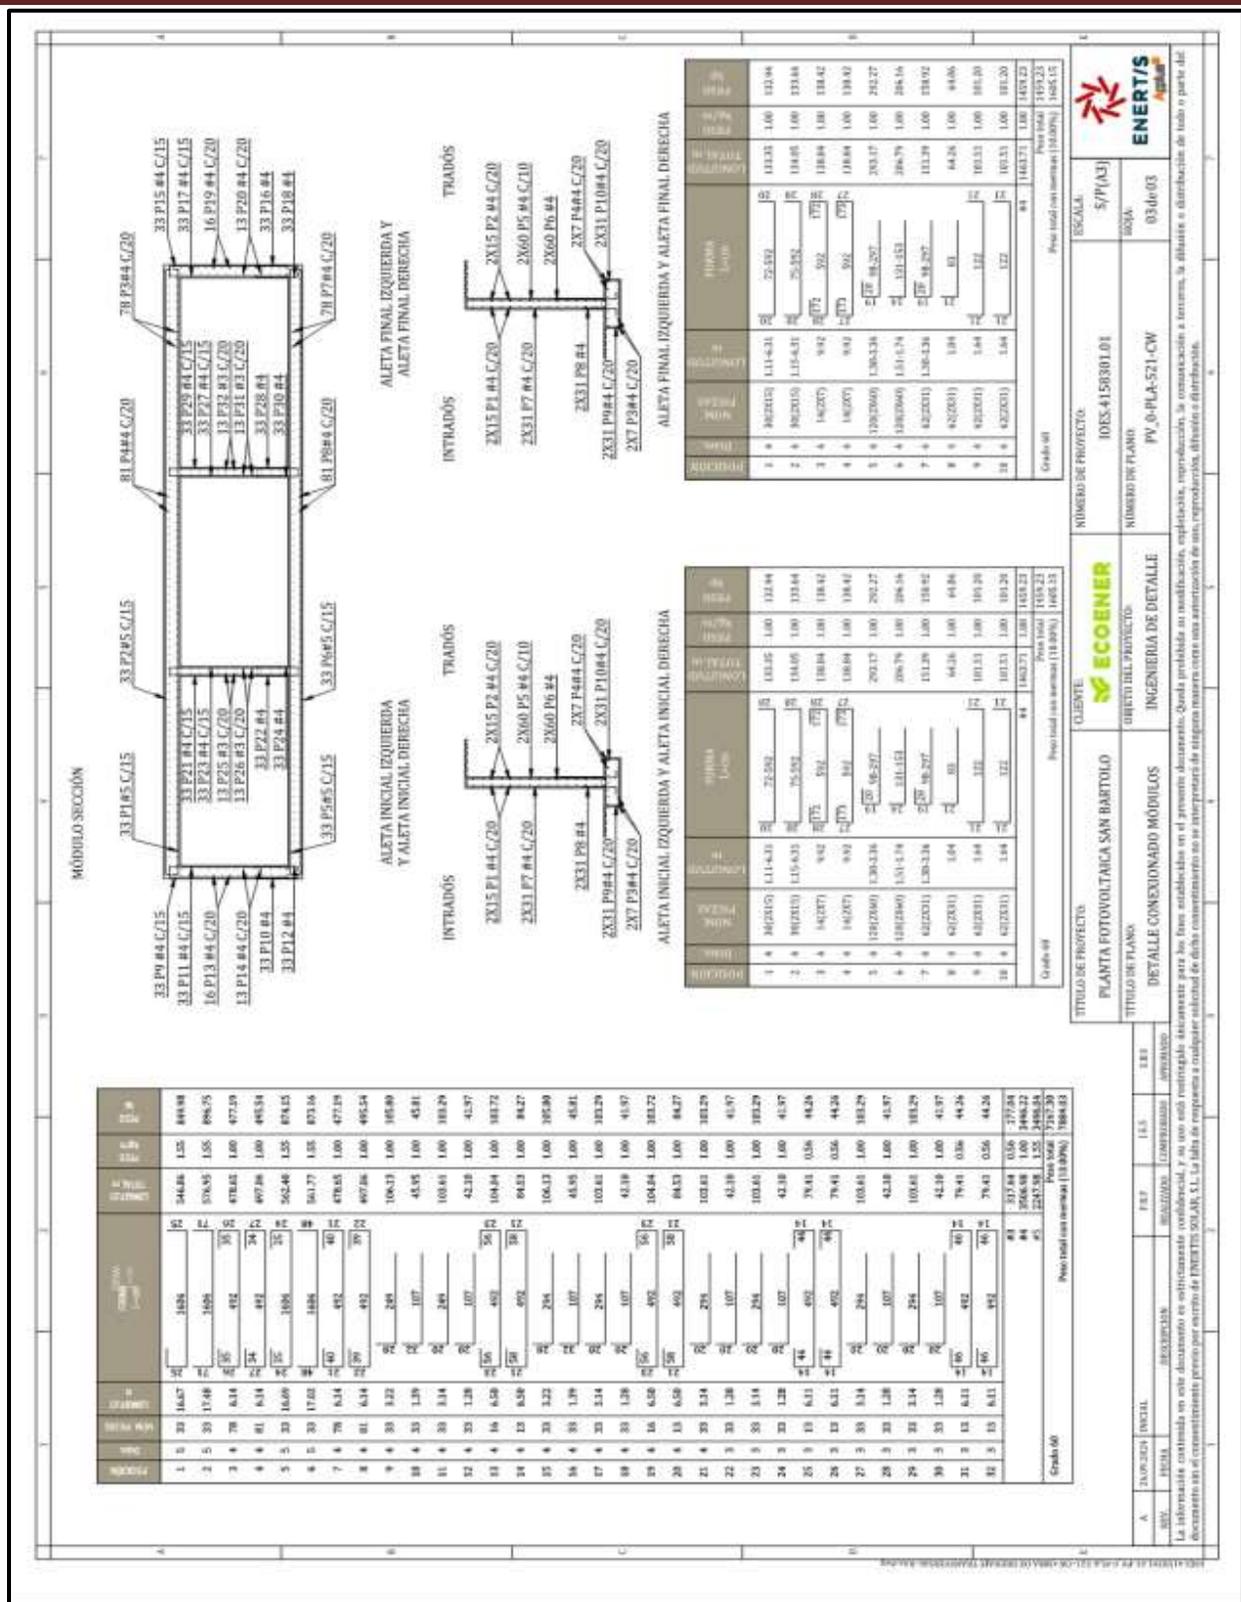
Planta arquitectónica (detalles de las aletas inicial y final - izquierda y derecha).
